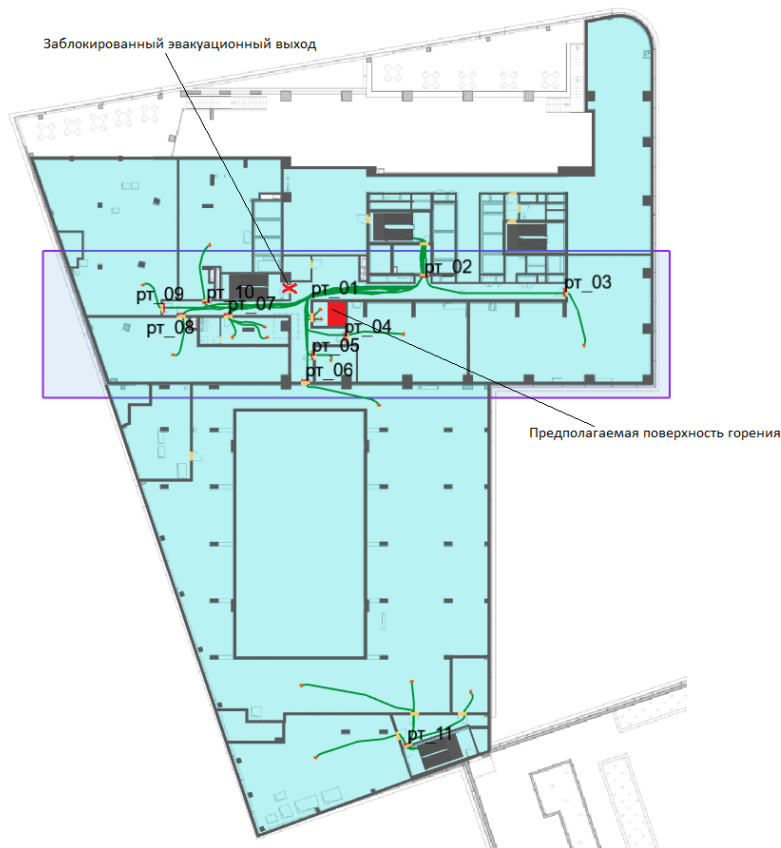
План 2-го этажа и нанесенная на него расчетная (принципиальная) схема эвакуации
